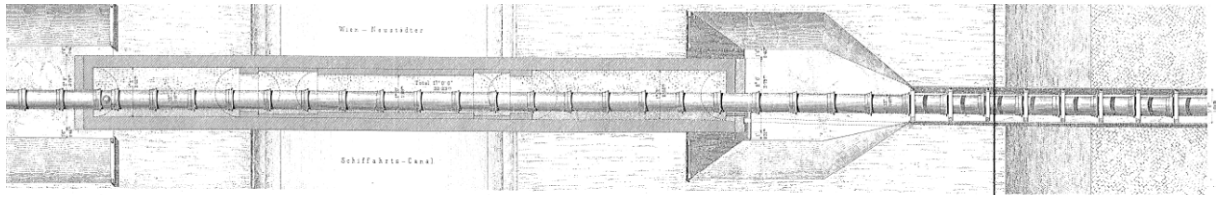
Grundriss Unterfahrung des Wiener-Neustädter Schiffahrtskanals
